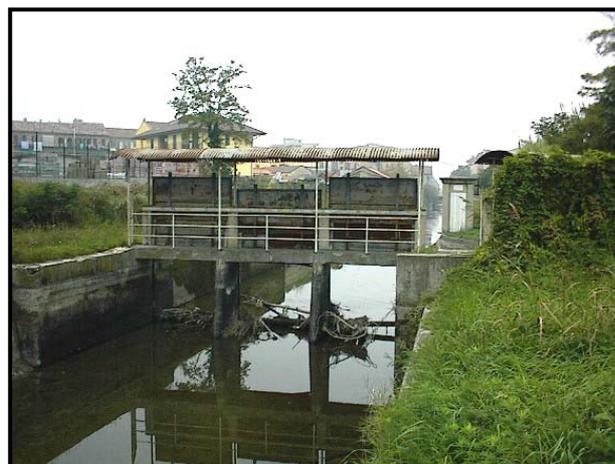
Vista da monte delle tre paratoie che regolano il deflusso lungo il canale Lanza.
